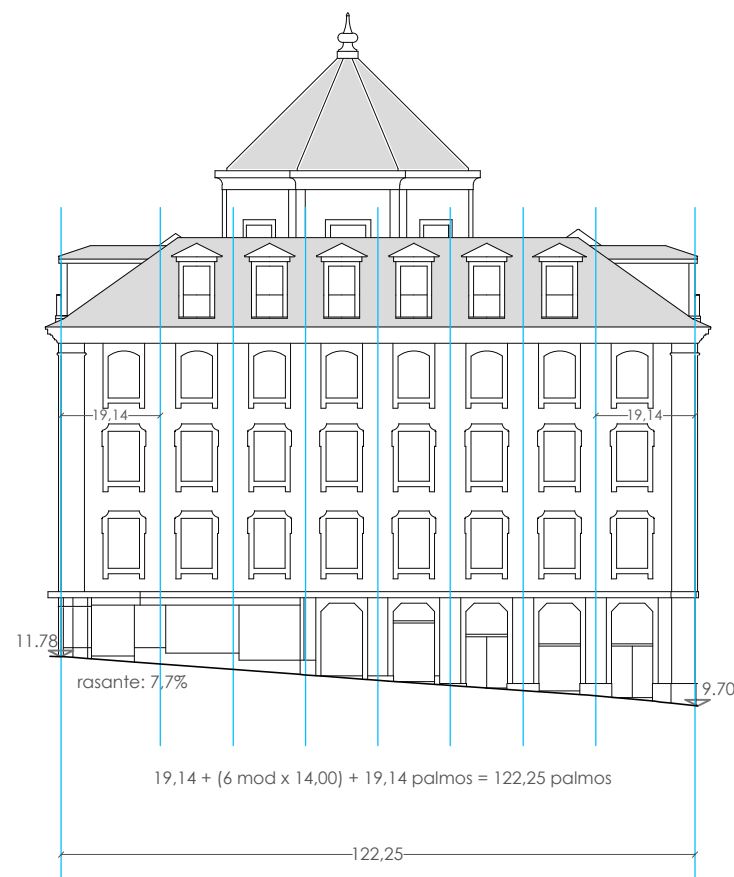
Rua da Vitória, fachada de una travessa.
